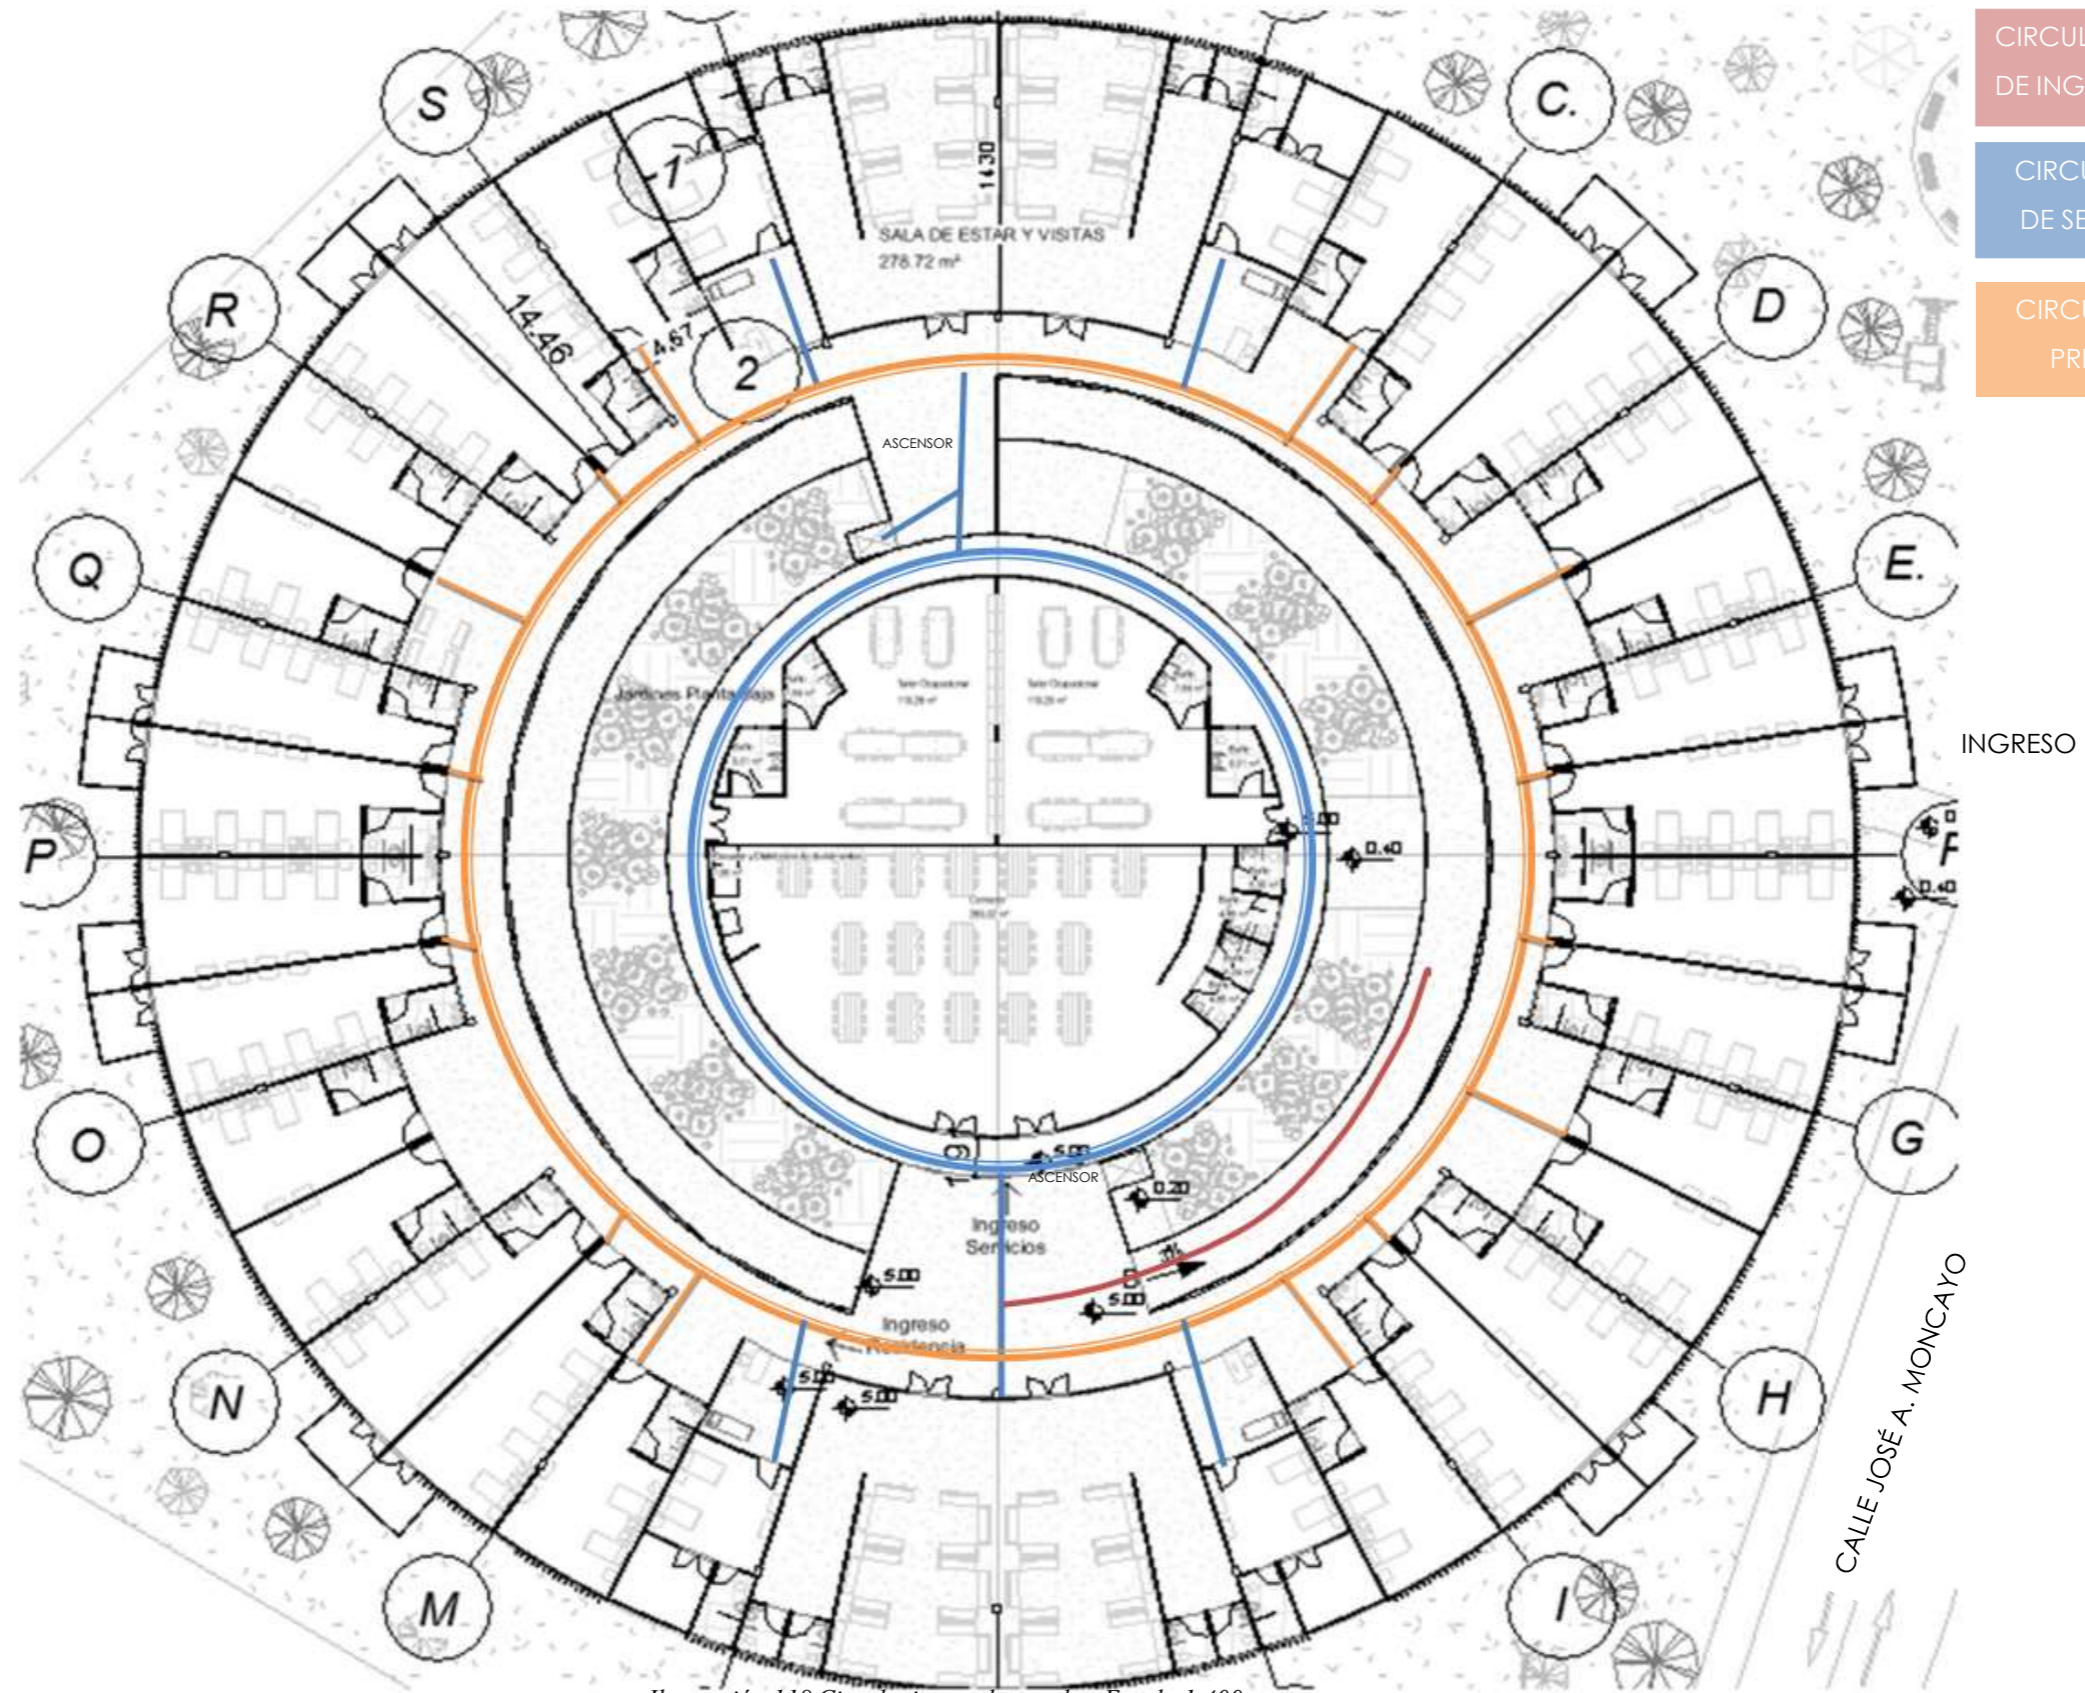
Circulaciones planta baja. Escala 1.400.
